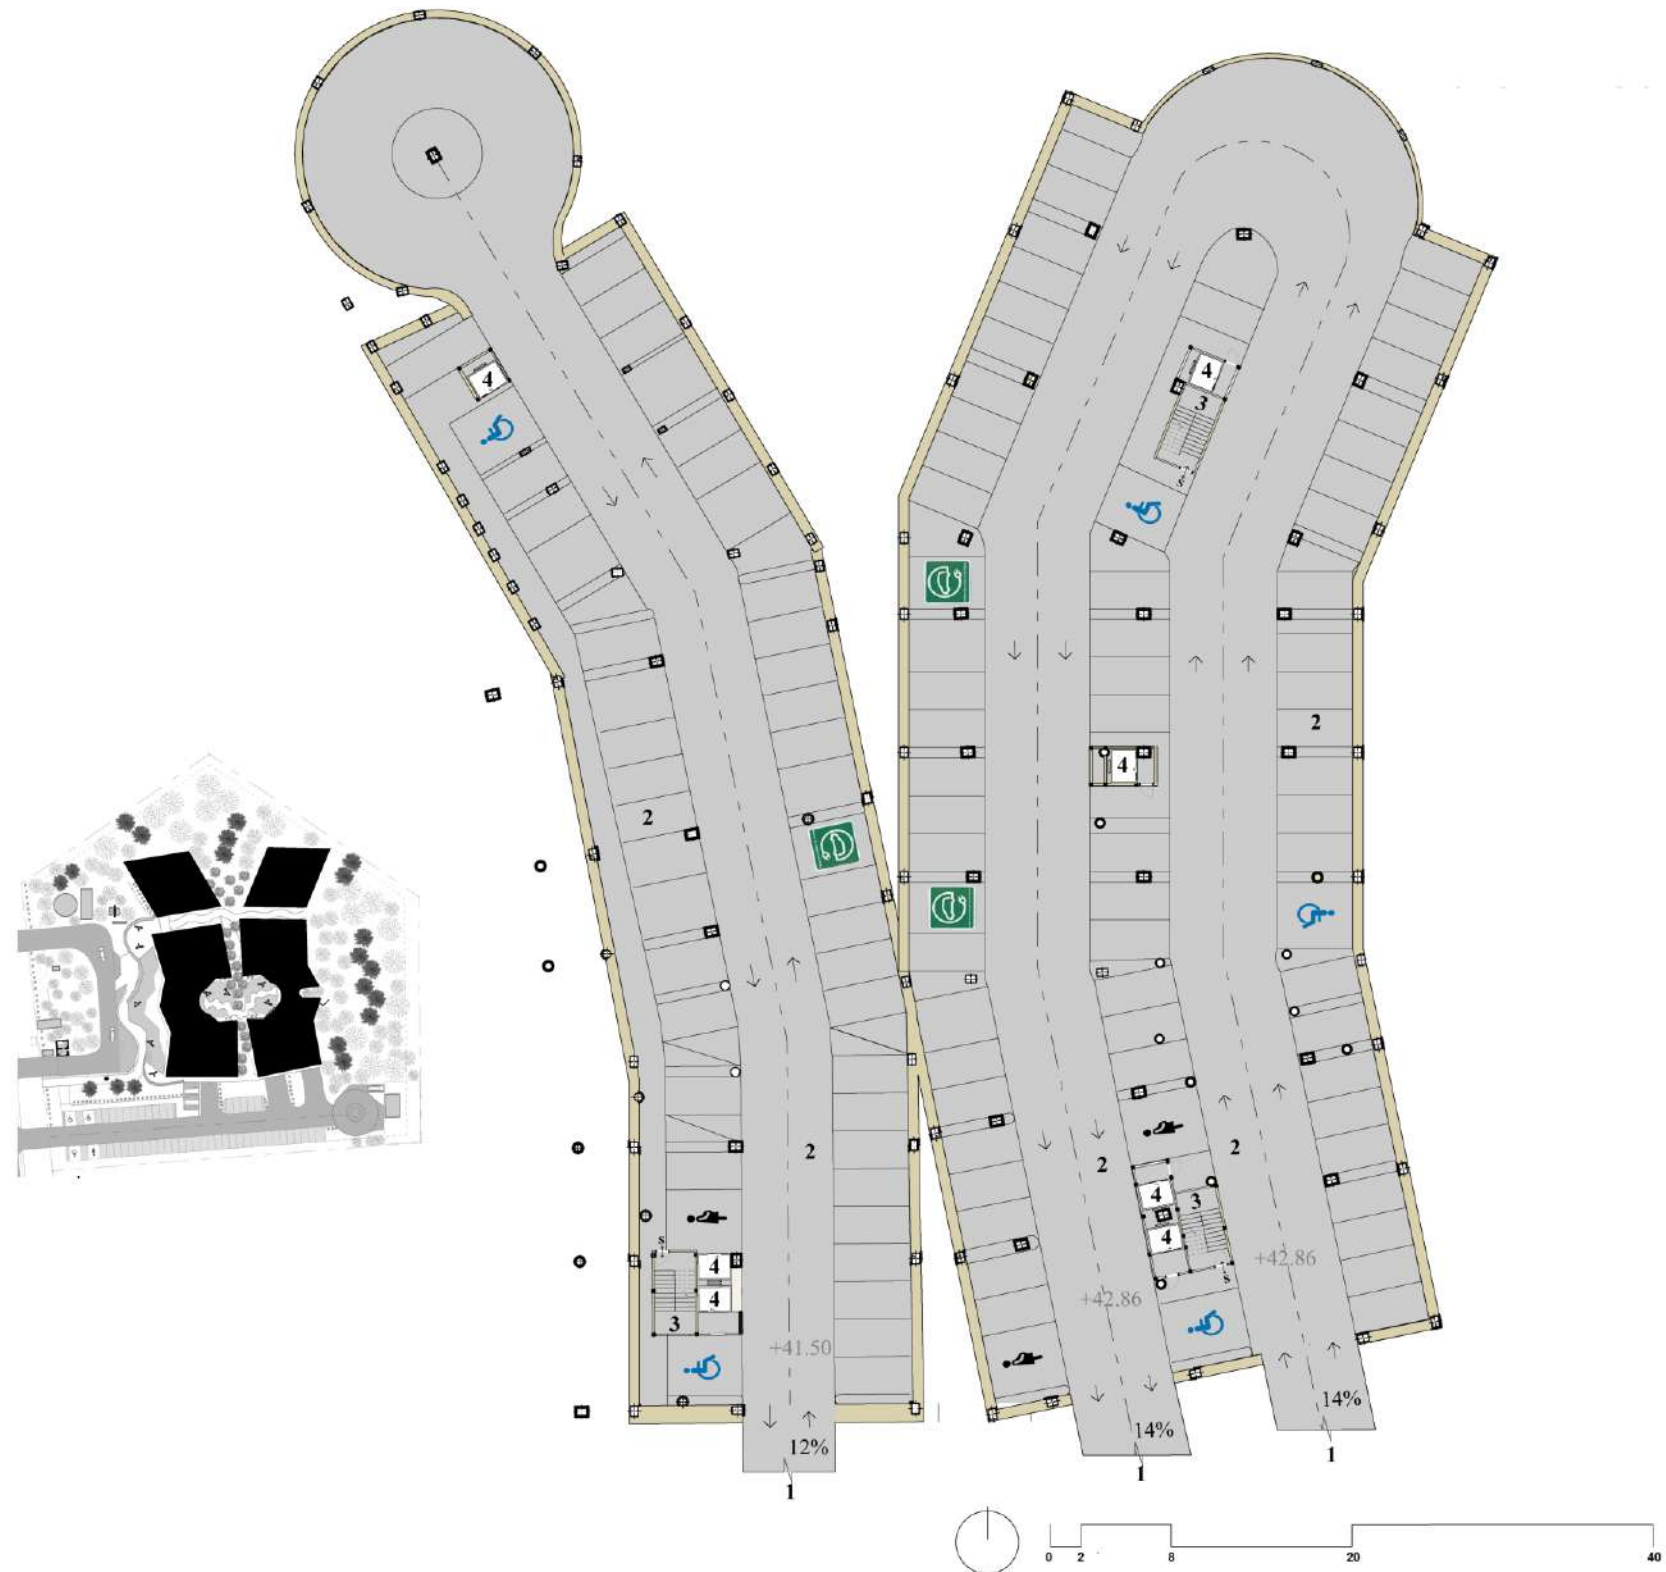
Planta Arquitectónica de estacionamientos soterrados, edificio A y B, elaborado por autor, 2024.
